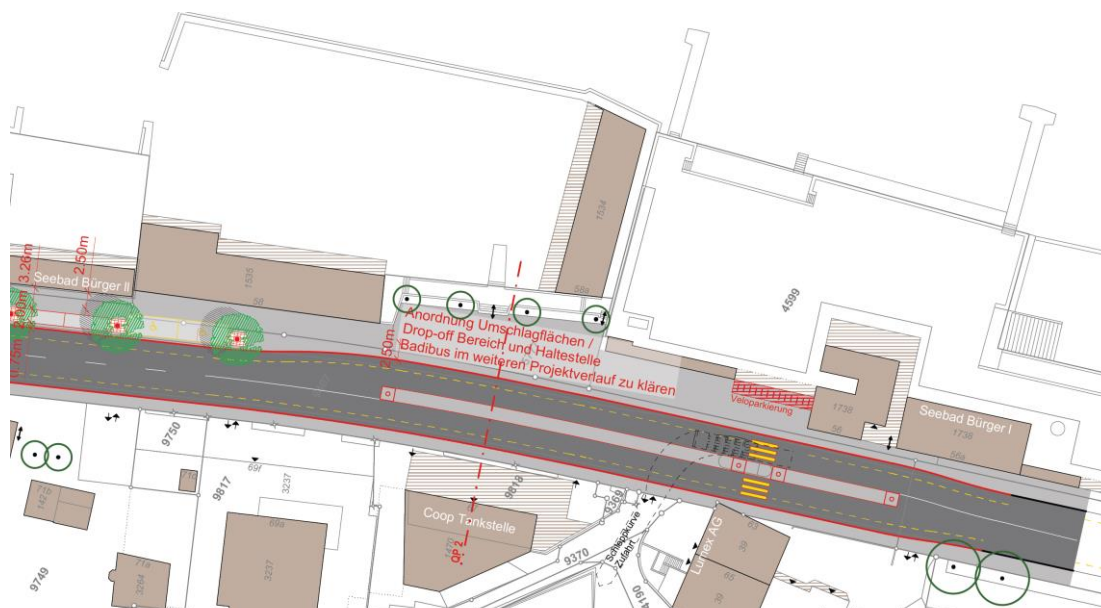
Ausschnitt aus Bestvariante vom 23.11.2016
